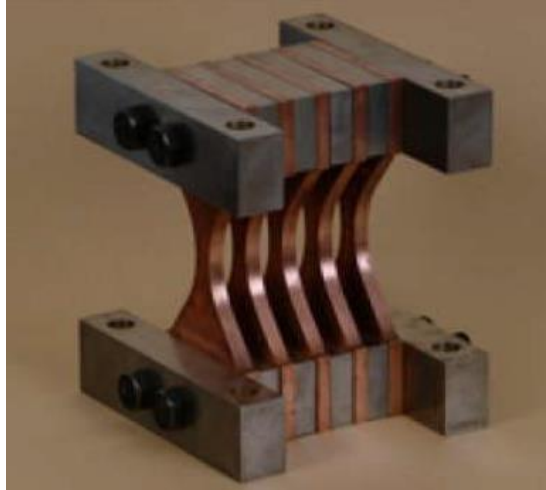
Disipador metálico tipo ADAS (Cámara Chilena de la Construcción, documento técnico N°29)
